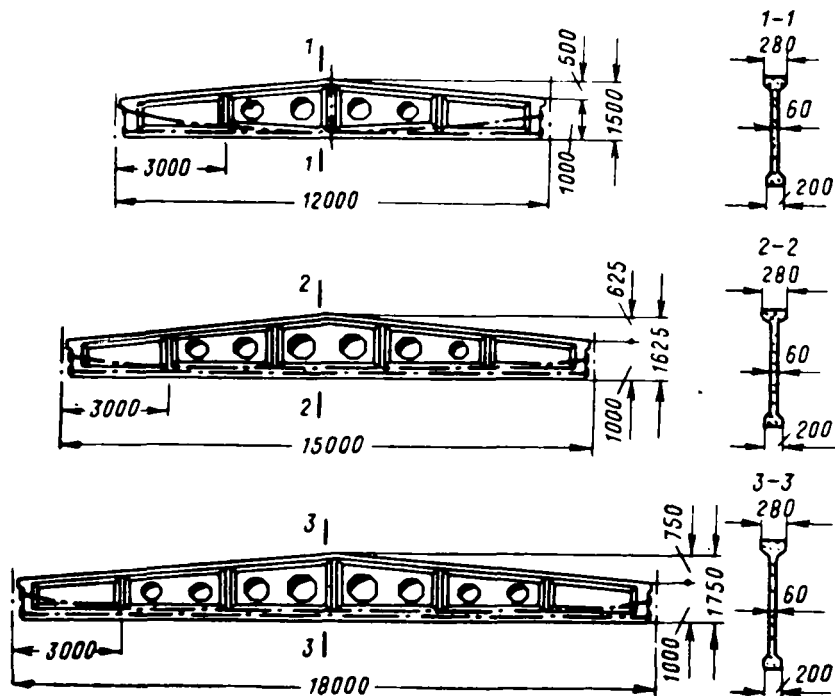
Предварительно напряженные балки из блоков с натяжением арматуры на бетон (серия ПК-01-07)
